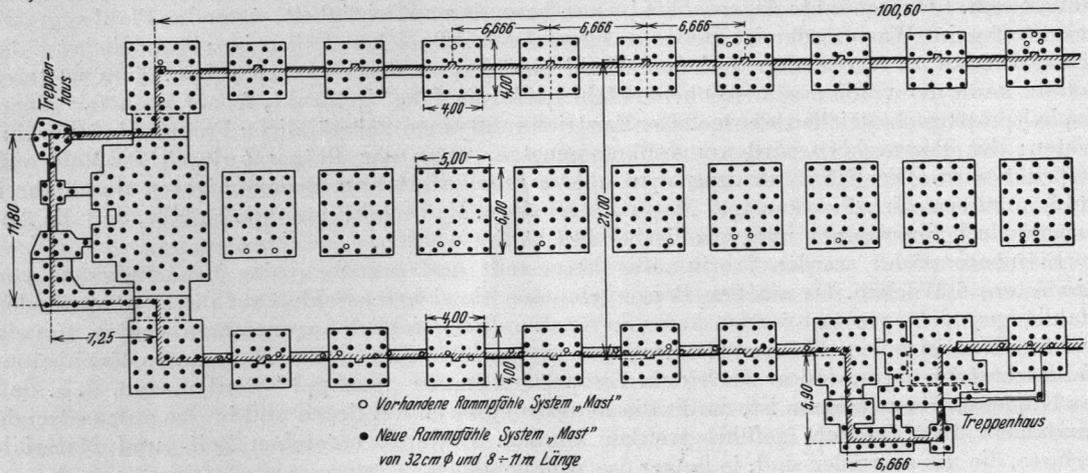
Ramm- und Fundamentplan eines Stahlskelett-Stockwerkbaues.
